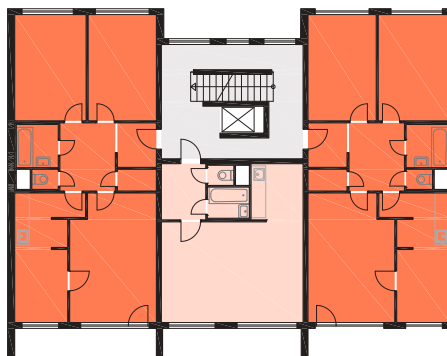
Konstrukční soustava VVÚ-ETA (Zdroj: panelovedomy.ekowatt.cz)
